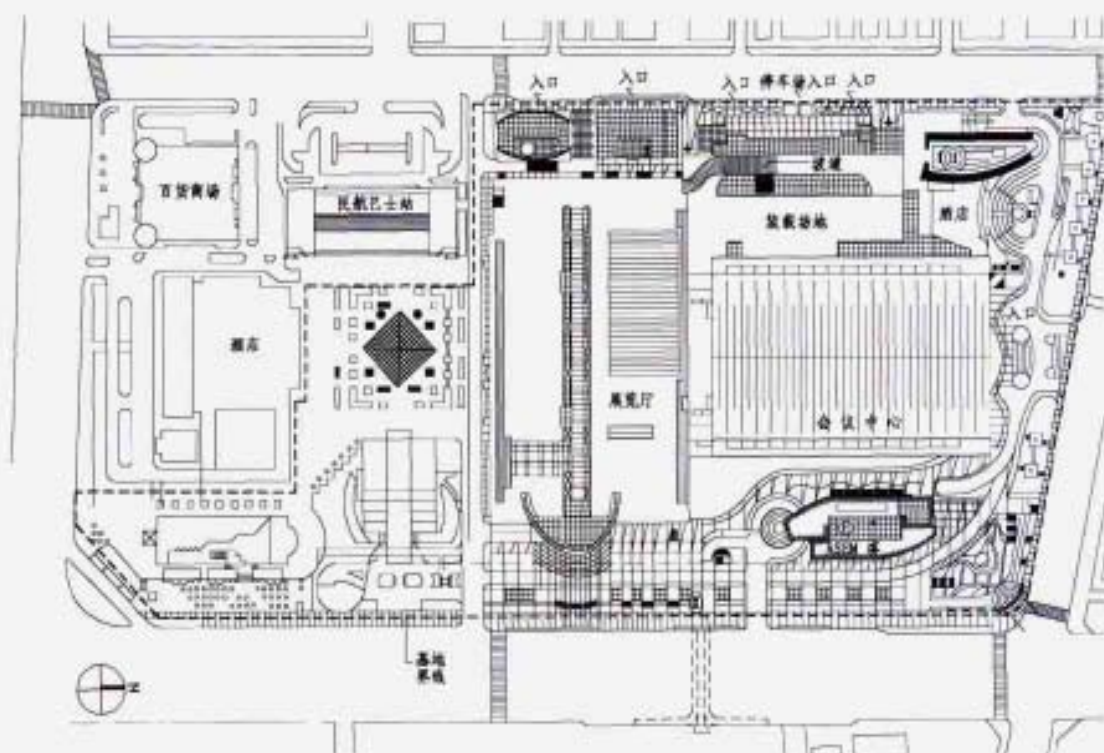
韩国汉城亚欧会议展览中心总平面图
